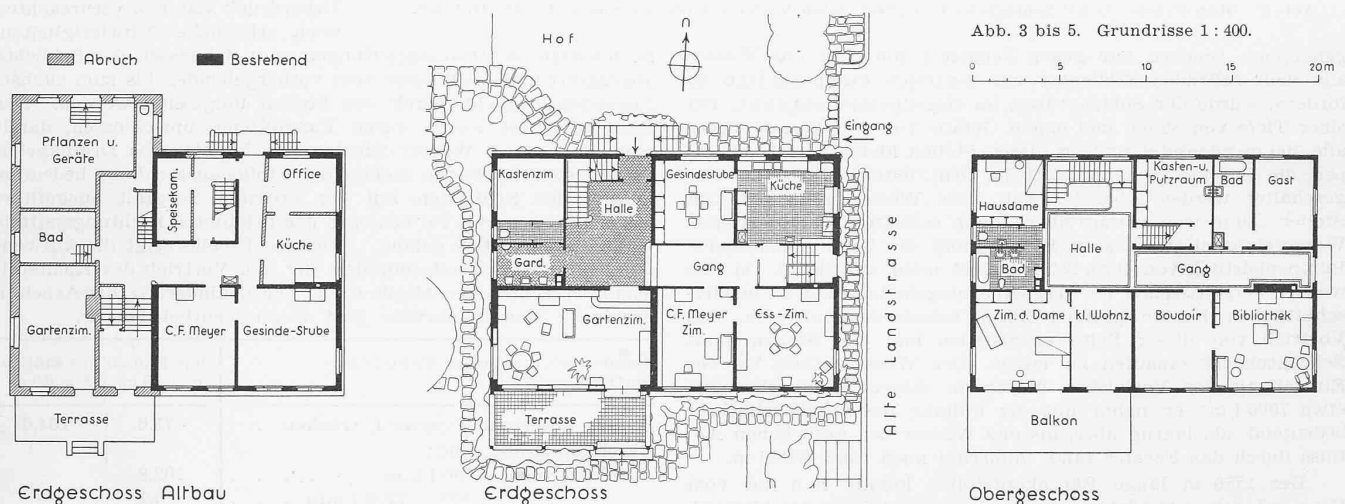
bis 5. Grundrisse 1:400.
